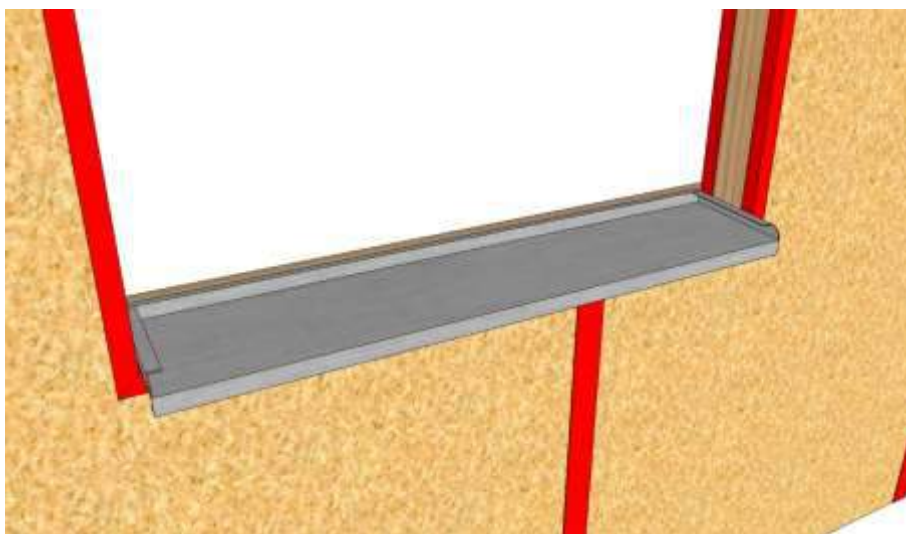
Mise en œuvre d'une pièce d'appui métallique, face extérieure du panneau
